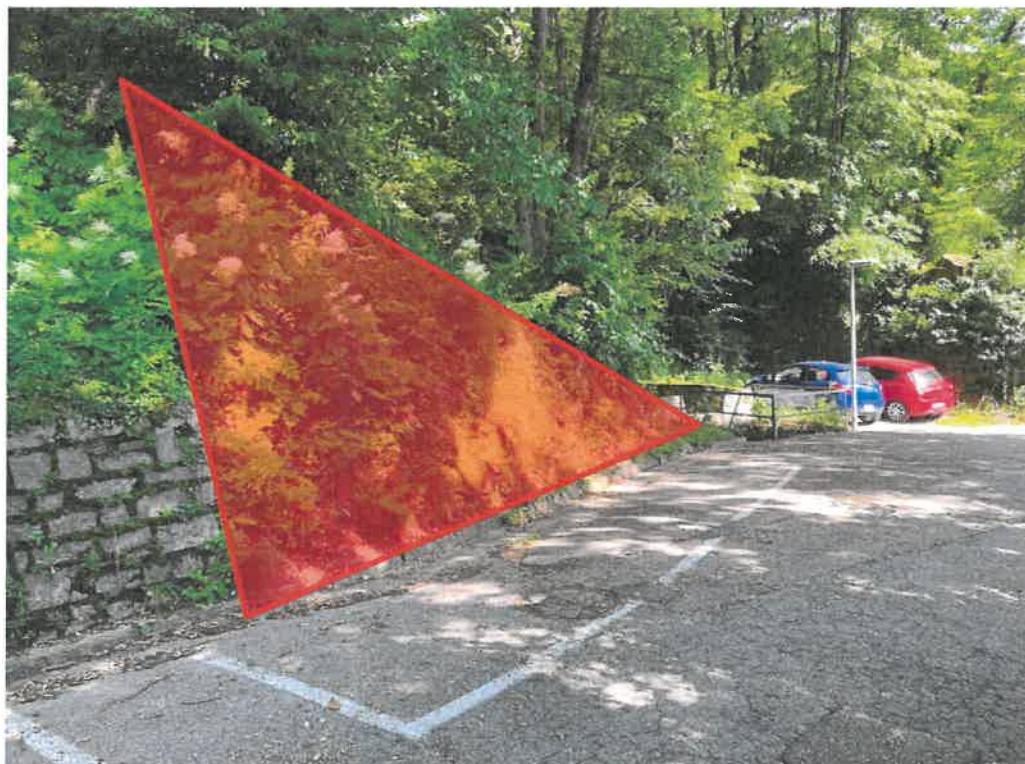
Zona boschiva interessata al dissodamento temporaneo
